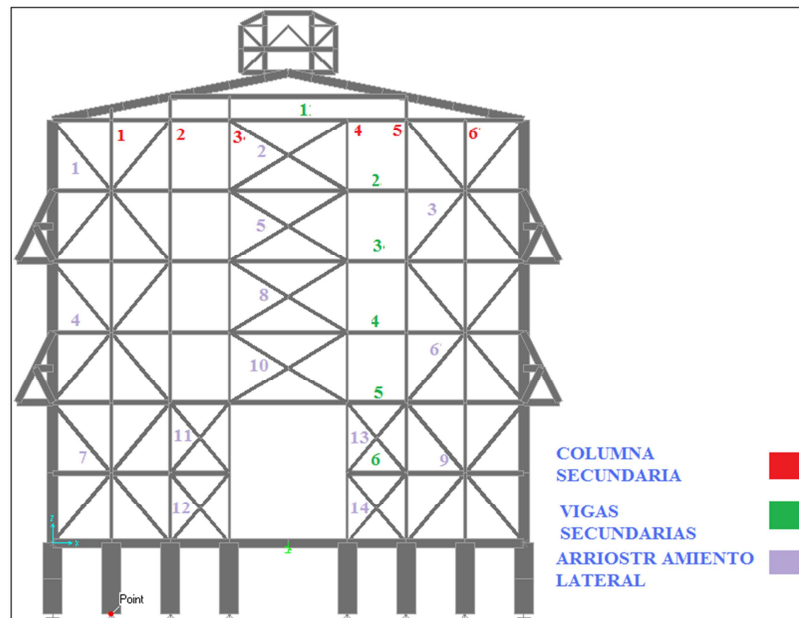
Columnas secundarias, vigas secundarias y arriostramiento lateral.
